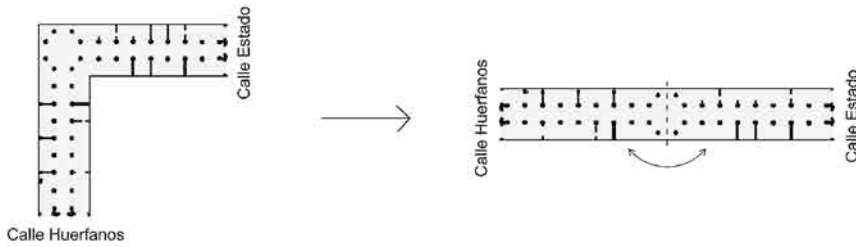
Dibujo del problema, planta esquemática. Fuente: elaboración propia.
